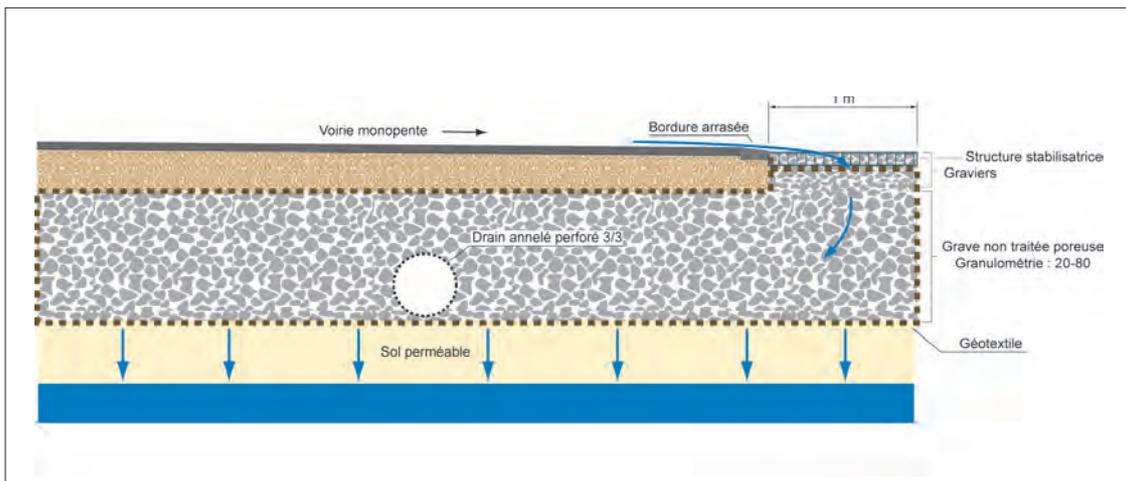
COUPE EN TRAVERS VOIRIE EN MONO-PENTE & RIVE DRAINANTE
